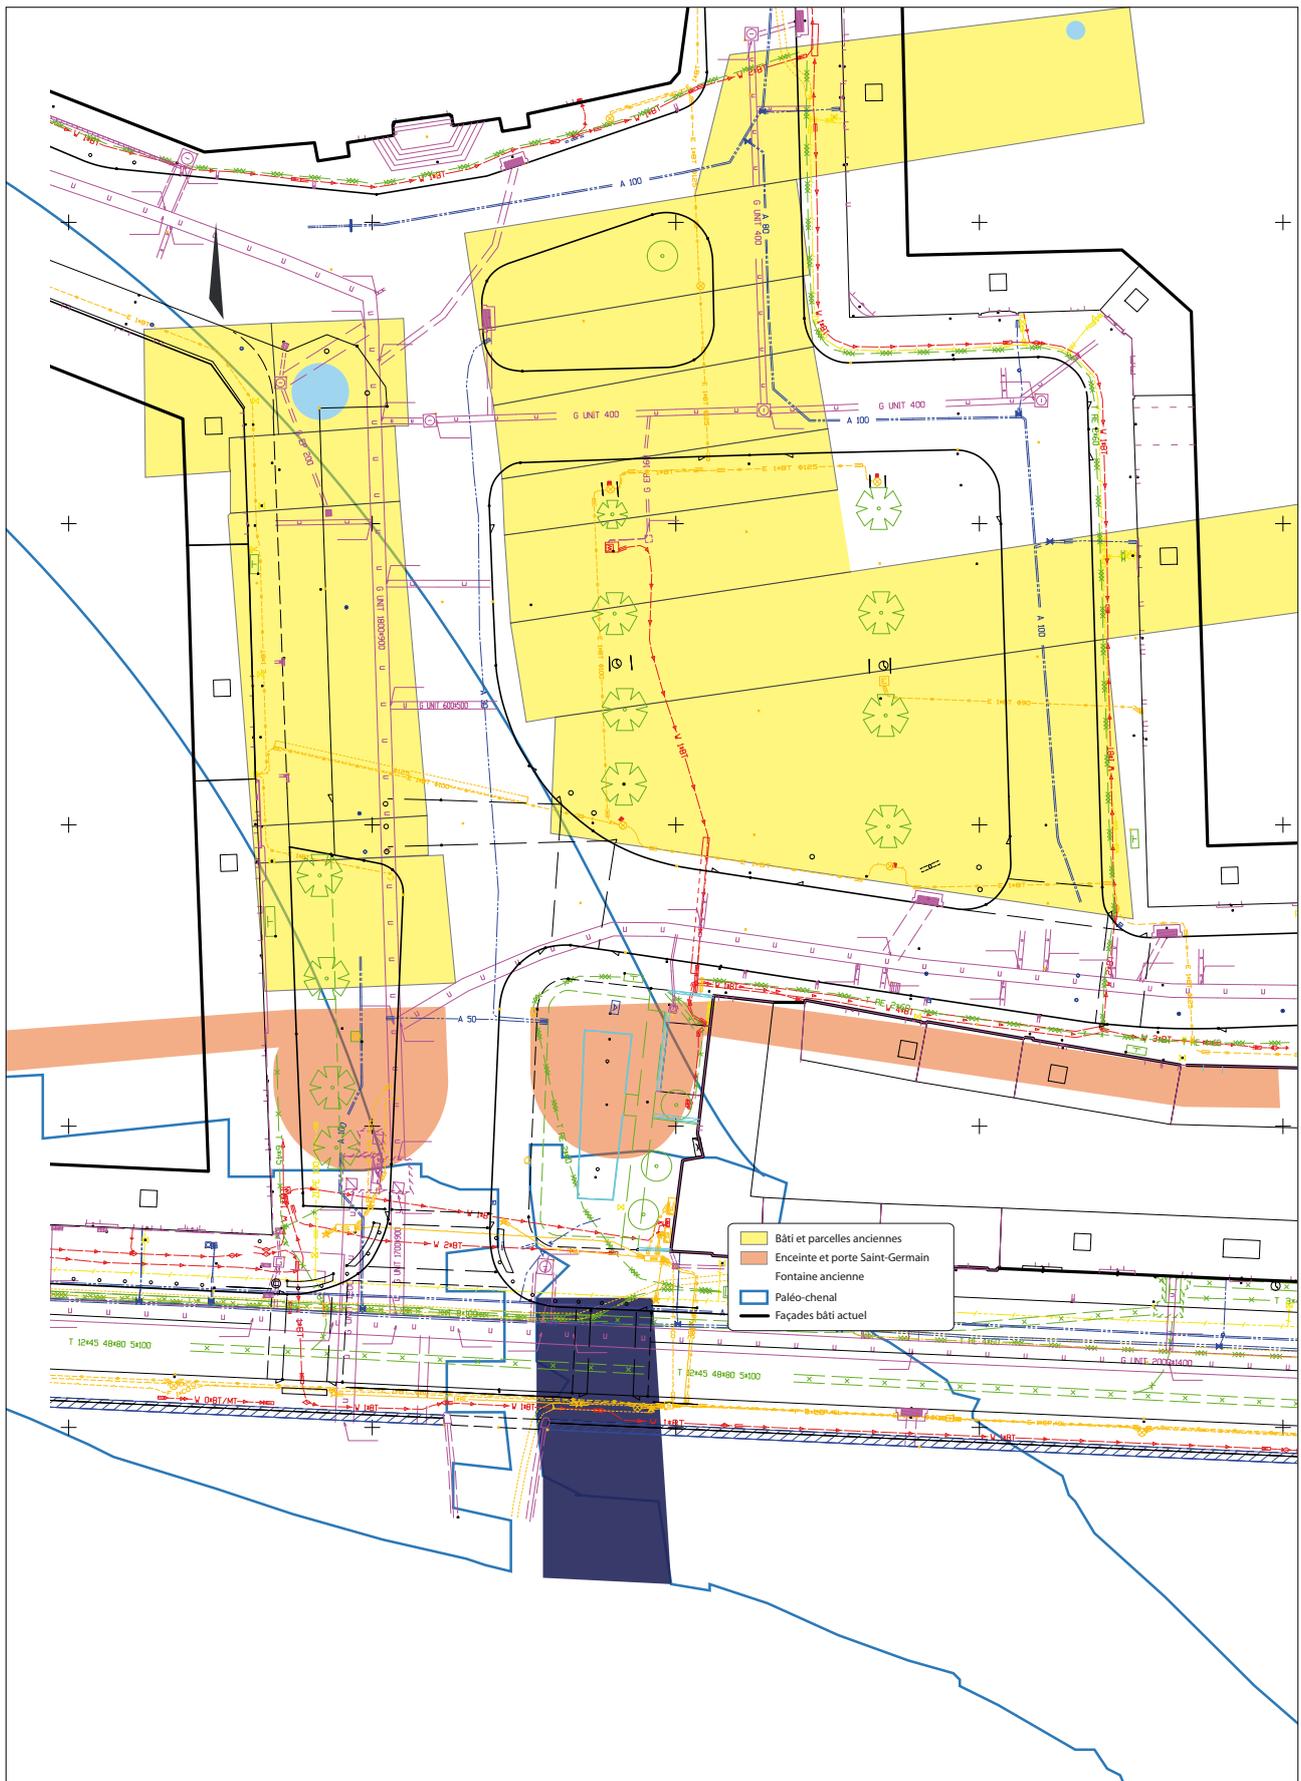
Plan des réseaux sous la place Saint-Germain, sur l'emprise des vestiges archéologiques.
